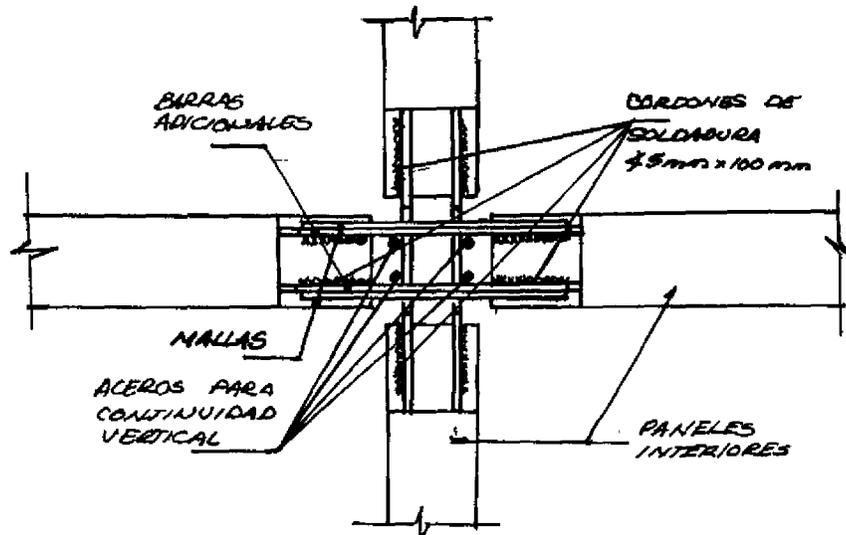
DETALLADO ACTUAL DE LOS ACEROS DE LAS JUNTAS DENTADAS DE LOS SISTEMAS DE GRANDES PANELES.
